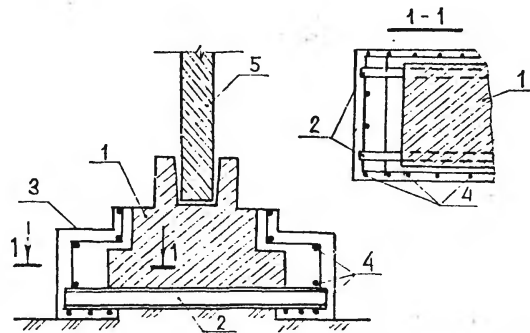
Увеличение опорной площади железобетонного столбчатого фундамента
